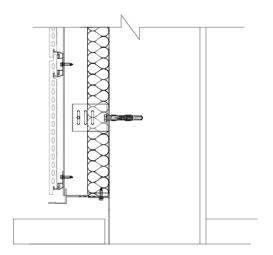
Kit Tempio® FK. Arranque de fachada.
